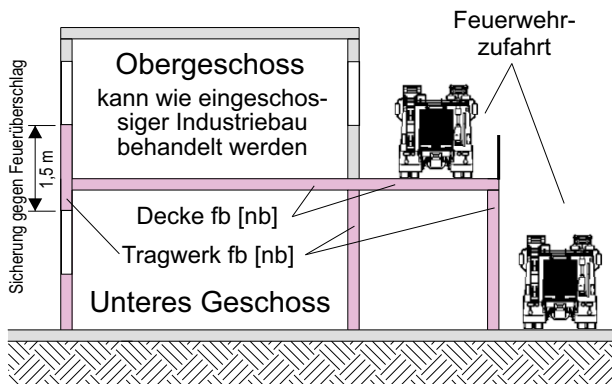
Beispiel für einen zweigeschossigen Industriebau mit Feuerwehrezufahrten zu jedem Geschoss
